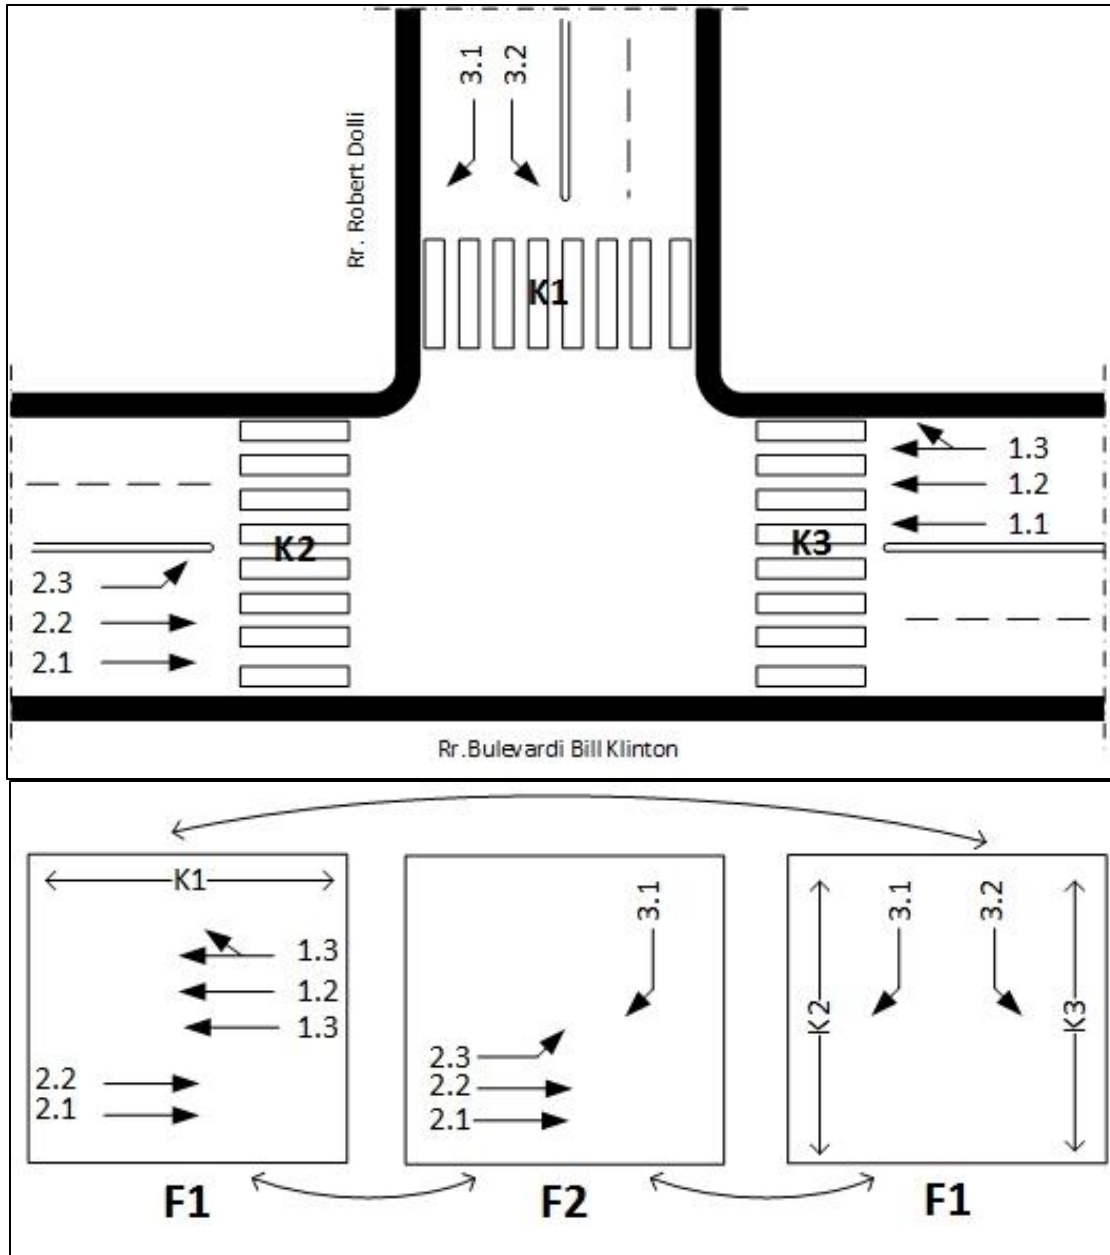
Gjendja ekzistuese e Udhëkryqit 1 dhe planit fazor të tij.
